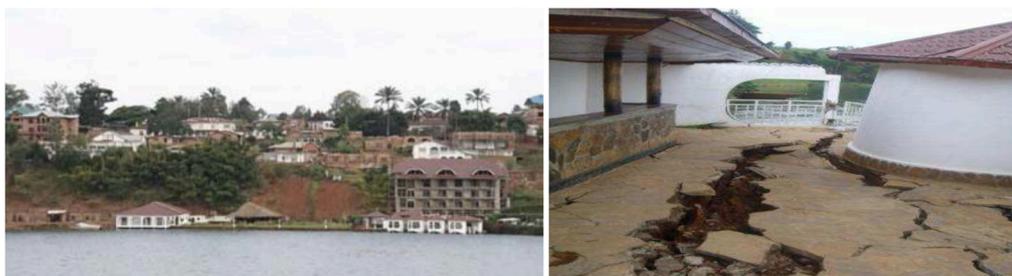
Risque d'éboulement Photo 5 : Fissure de l'hôtel la Roche
